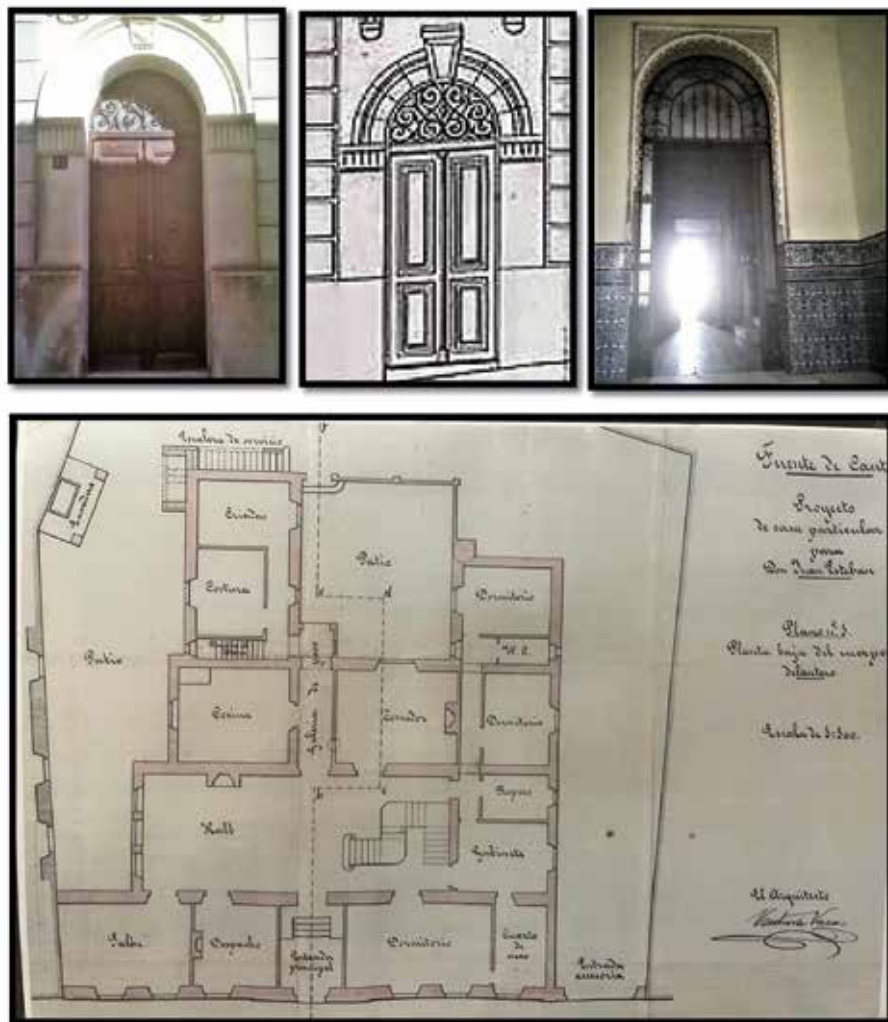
a 607. Puerta de entrada, boceto de la misma y puerta interior situada en el hall dando a la galería de paso al patio. Friso de azulejos tan típico de su arquitectura. Fuente: Plano procedente del archivo familiar de D. Juan Manuel Murillo Carrascal, así como la foto-grafía, tomada por él mismo.
